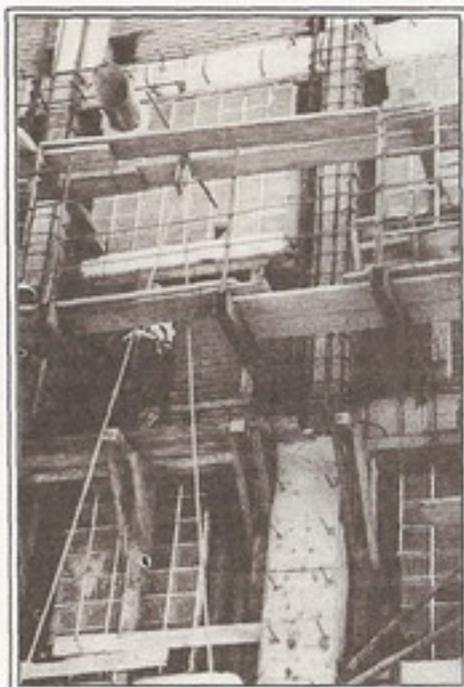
Reforzamiento sísmico utilizando encamisado de elementos estructurales. Torre de Molienda, Molinos de Costa Rica, Alajuela.
